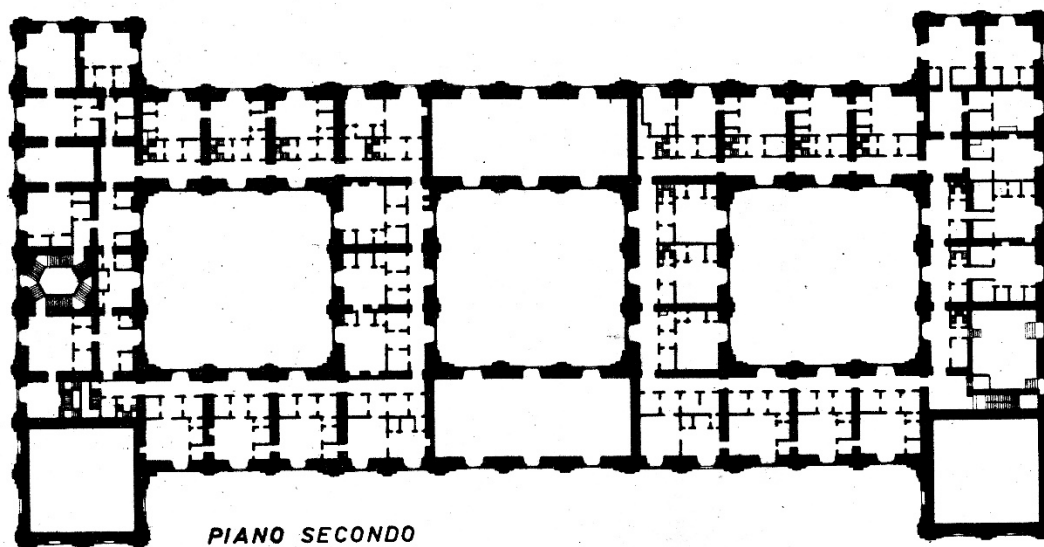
Rilievo dello stato dei luoghi, pianta del secondo piano, 1951-52, Archivio della Fondazione E.B. De Felice
